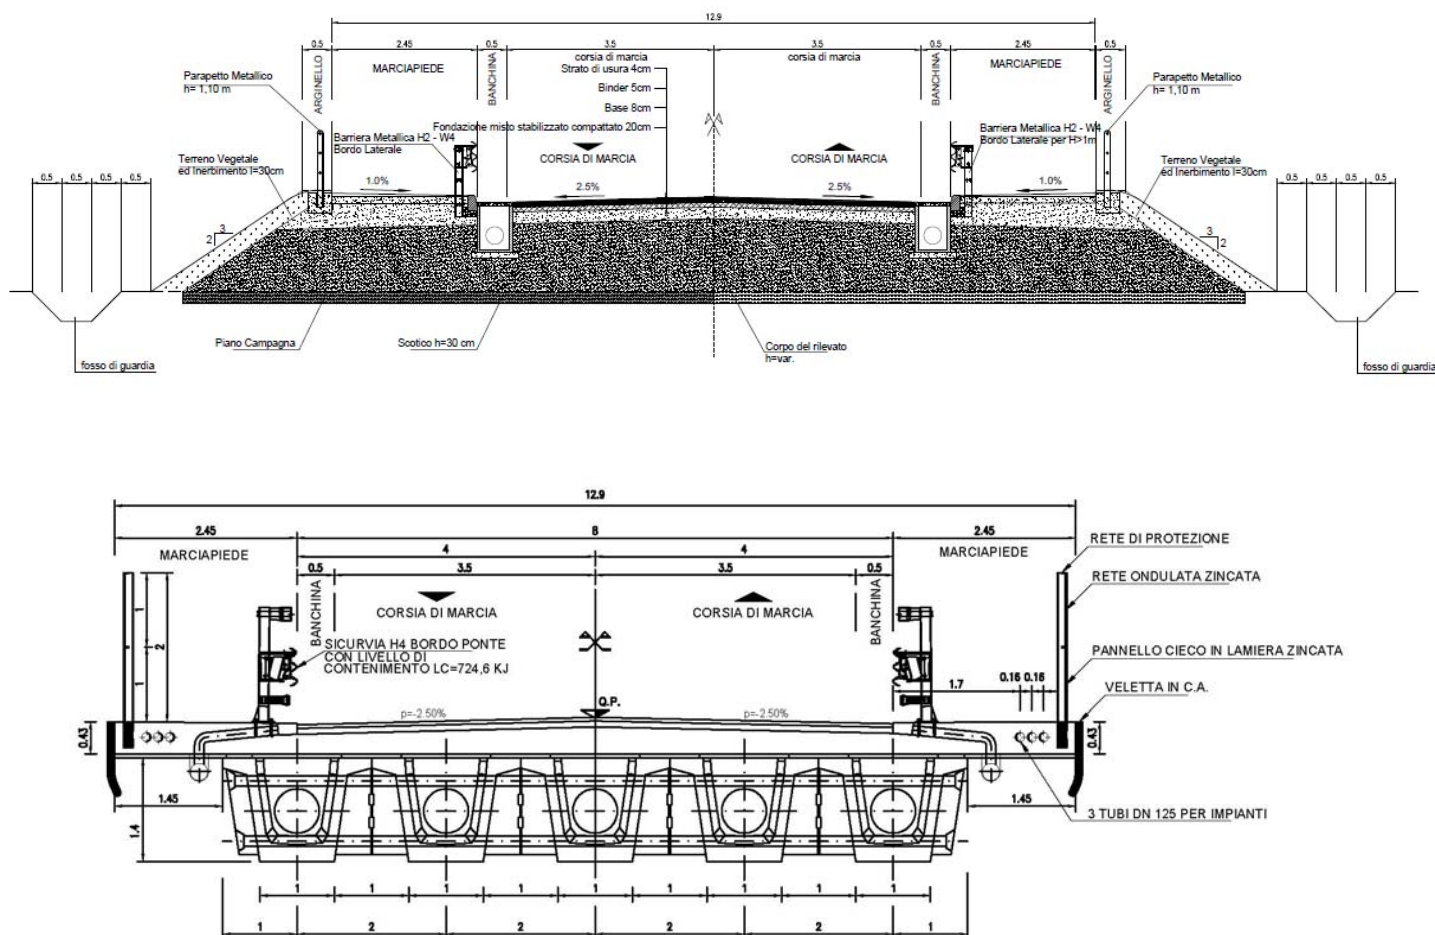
Sezioni Tipo rilevato e cavalcaferrovia
